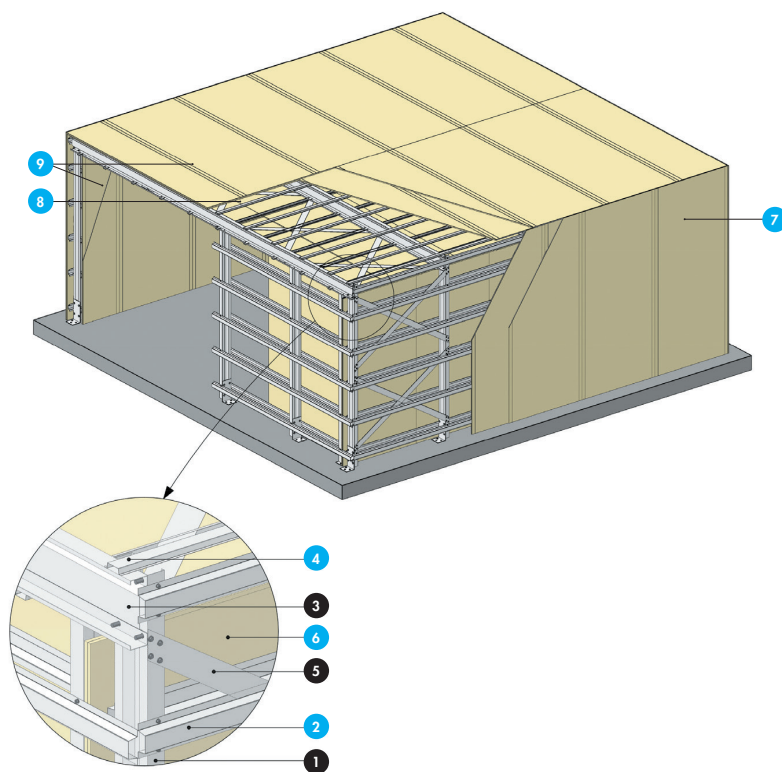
EI 30 - Cloisons : 2 KS 13 par parement - Plafond : 2 KS 13 par parement
